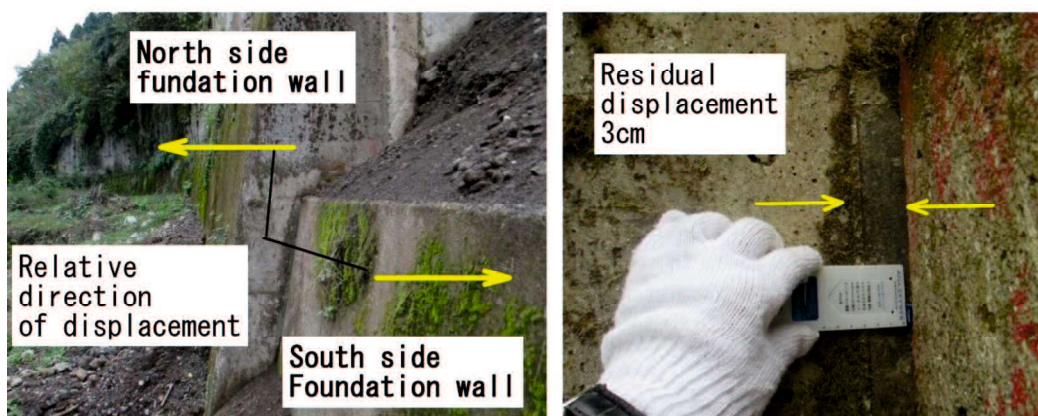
補強土壁基礎コンクリート擁壁の施工継ぎ目に生じた崩壊部側基礎の地山側への3cm水平移動
